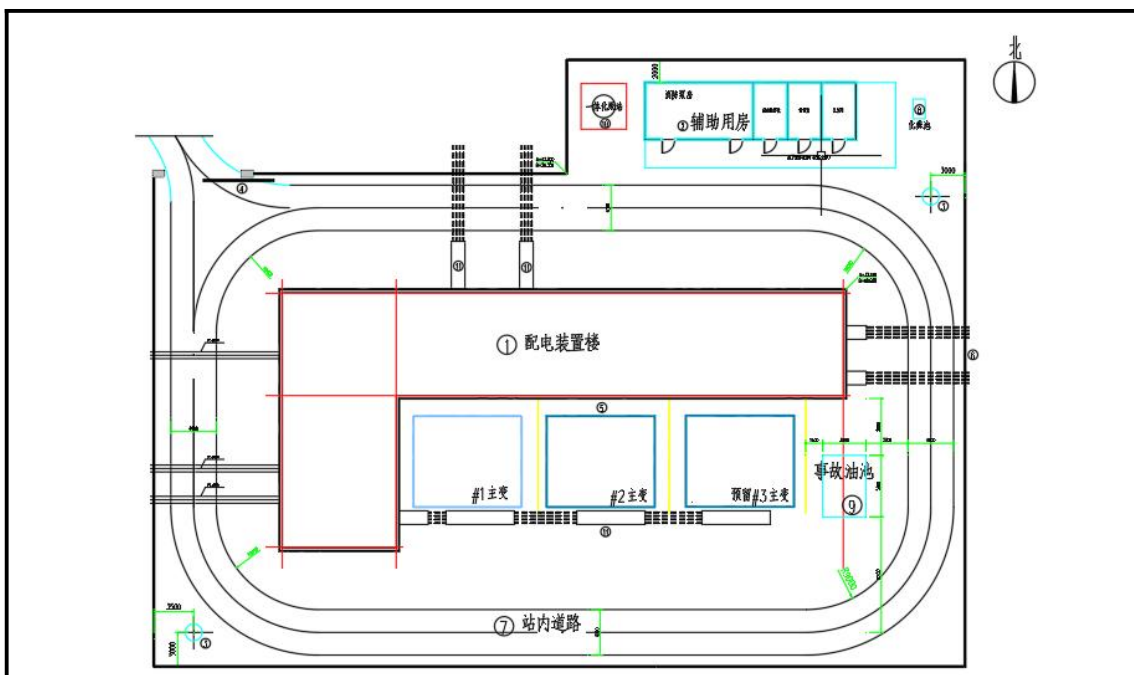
先烈 110 千伏变电站土建总平面布置图
